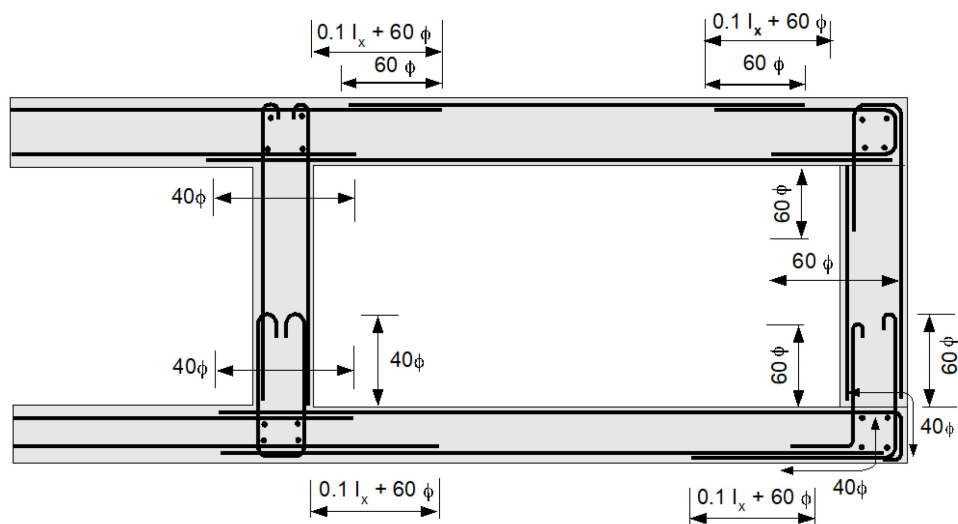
Typische Bewehrungsführung in Decke, Wand, Zwischenwand und Fundamentplatte (nur Biegebewehrung dargestellt)
